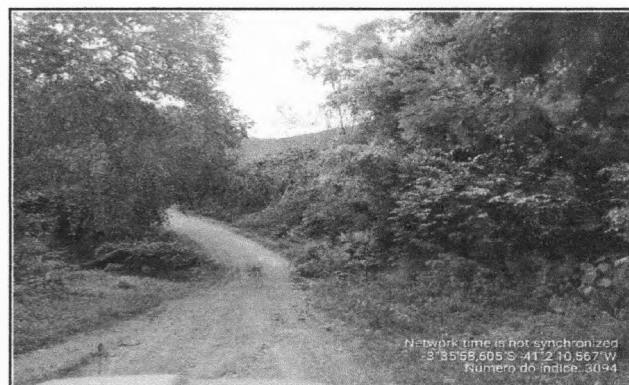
LOCAL DA CONSTRUÇÃO - BUEIRO
